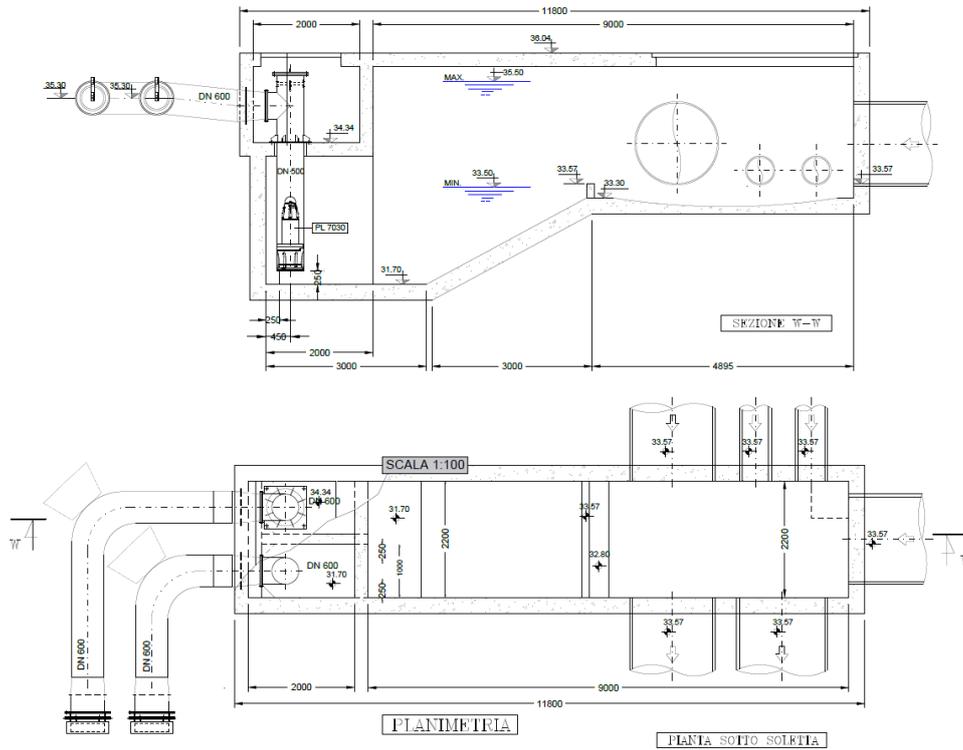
| Vista in sezione e pianta dell'impianto di sollevamento S2.
